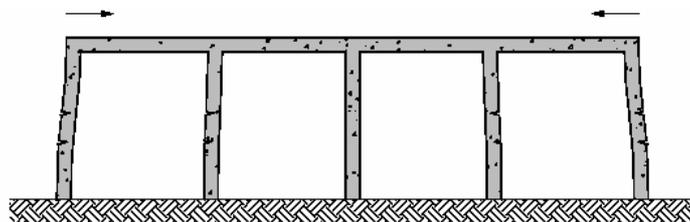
Fissuras horizontais nos pilares, devidas à retracção do betão das vigas superiores
